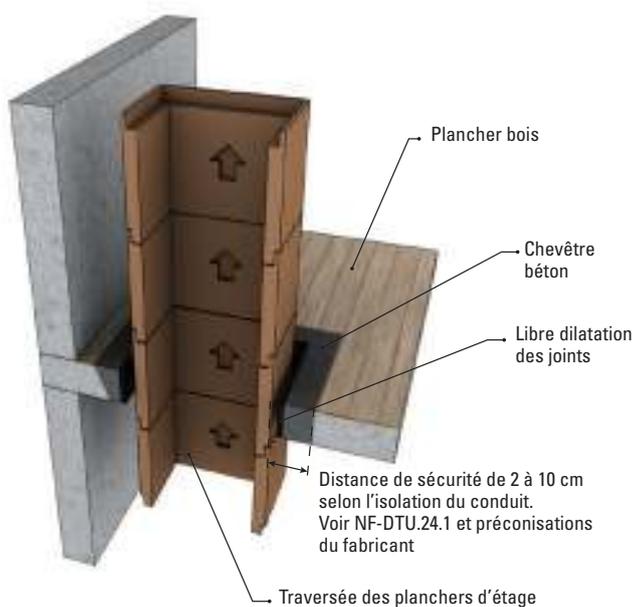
Exemple de traversée de plancher d'un conduit maçonné
